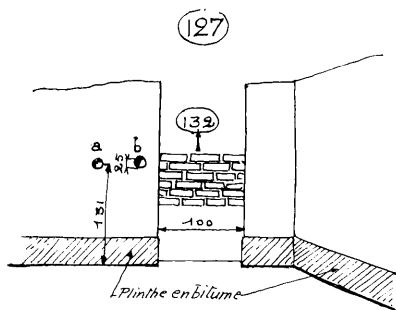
Salle 127. Élévation des murs, près de la porte murée 127-132.
